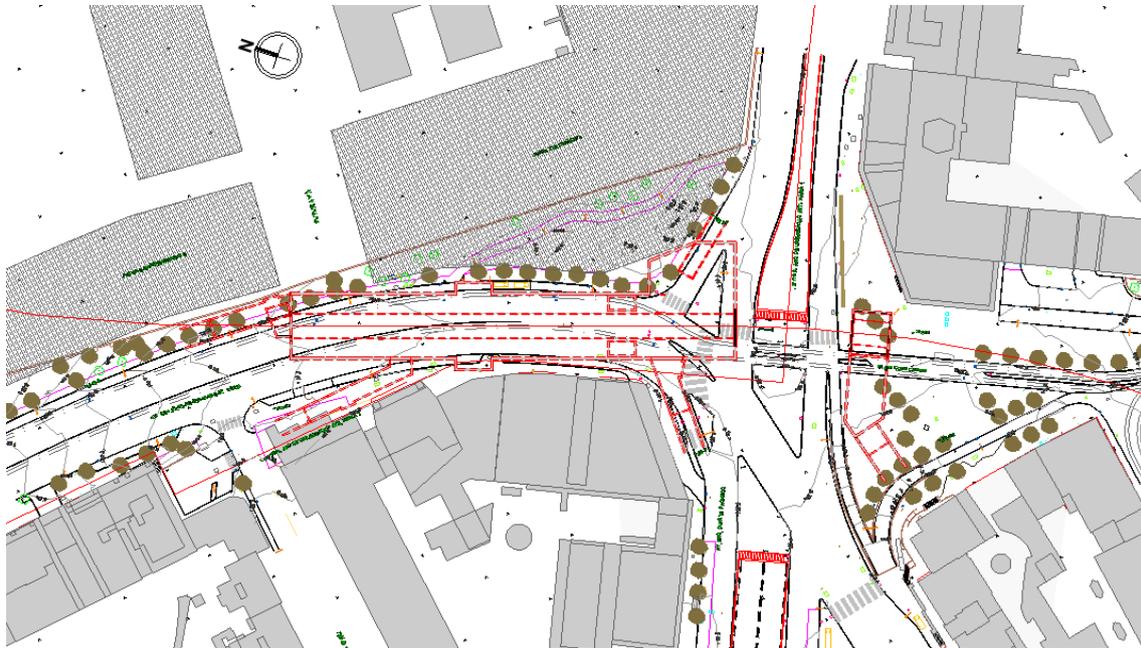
Planta de Implantação da Estação Campolide Amoreiras
